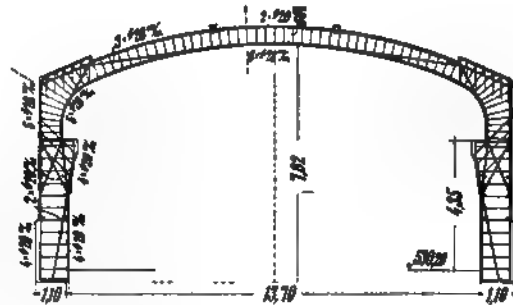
Rahmenkonstruktion (zu Abb. 378).
